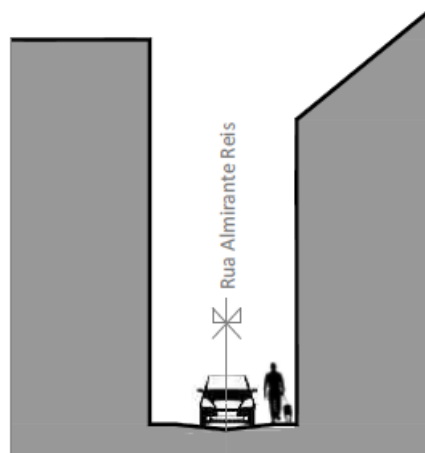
Perfil Transversal da proposta de requalificação da Rua Almirante Reis.
